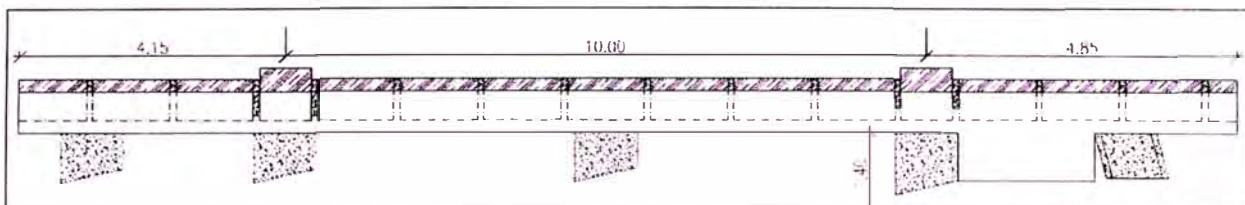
VISTA DE COLOCACIÓN DE LOSAS NERVADAS
